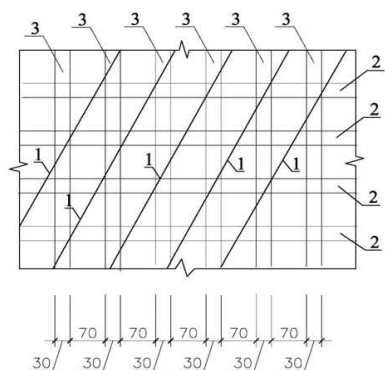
Принципиальная схема трещинообразования в железобетонных конструкциях здания ГЭС при его непроектной осадке:
